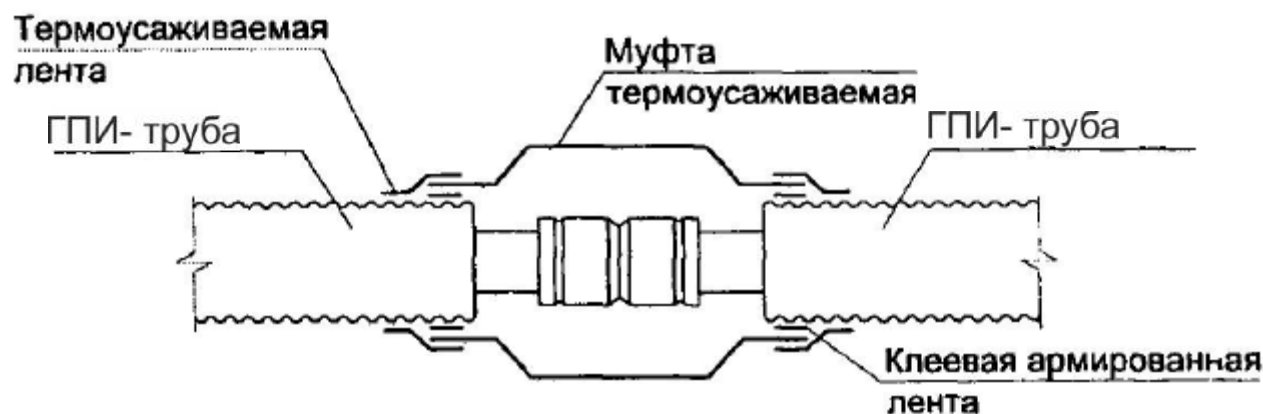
Узел теплогидроизоляции стыкового соединения ГПИ-труб
